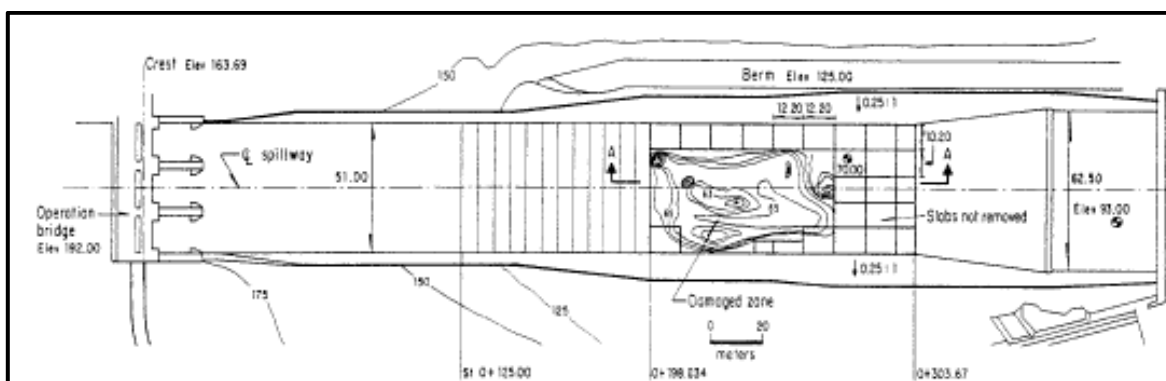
Planta de los daños ocurridos en el vertedor de servicio en 1970
